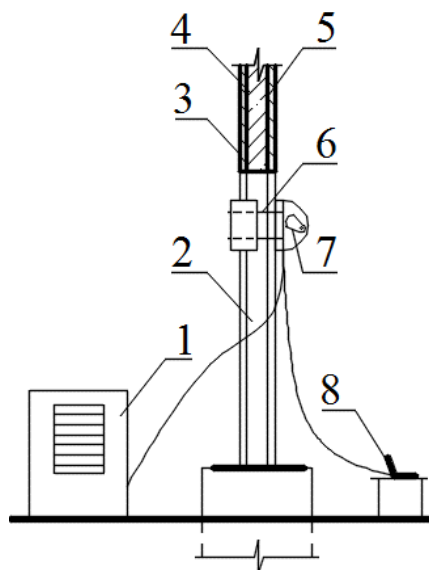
Схема процесу застосування керованих вібрацій при влаштуванні сталезалізо-бетонних вертикальних елементів: 1 – мобільне джерело живлення; 2 – колона; 3 – незнімна сталева опалубка; 4 – шар клею; 5 – бетонний блок; 6 – кріплення вібробуджувального обладнання; 7 – джерело керованих вібрацій; 8 – пульт керування
